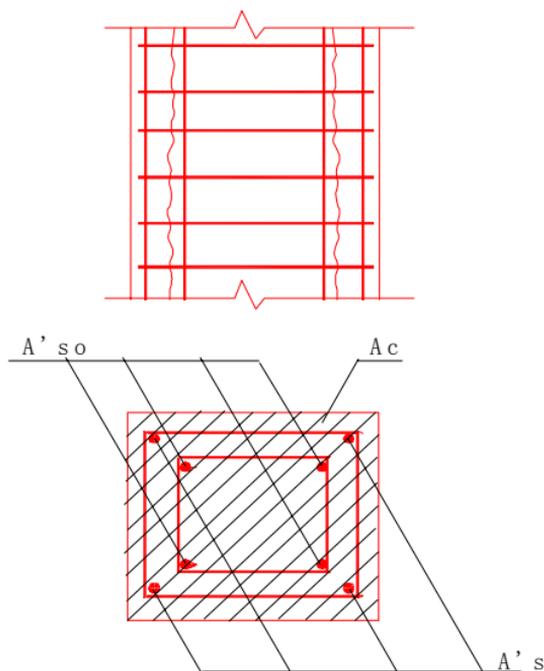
条 加大截面加固钢筋混凝土轴心受压构件截面图
